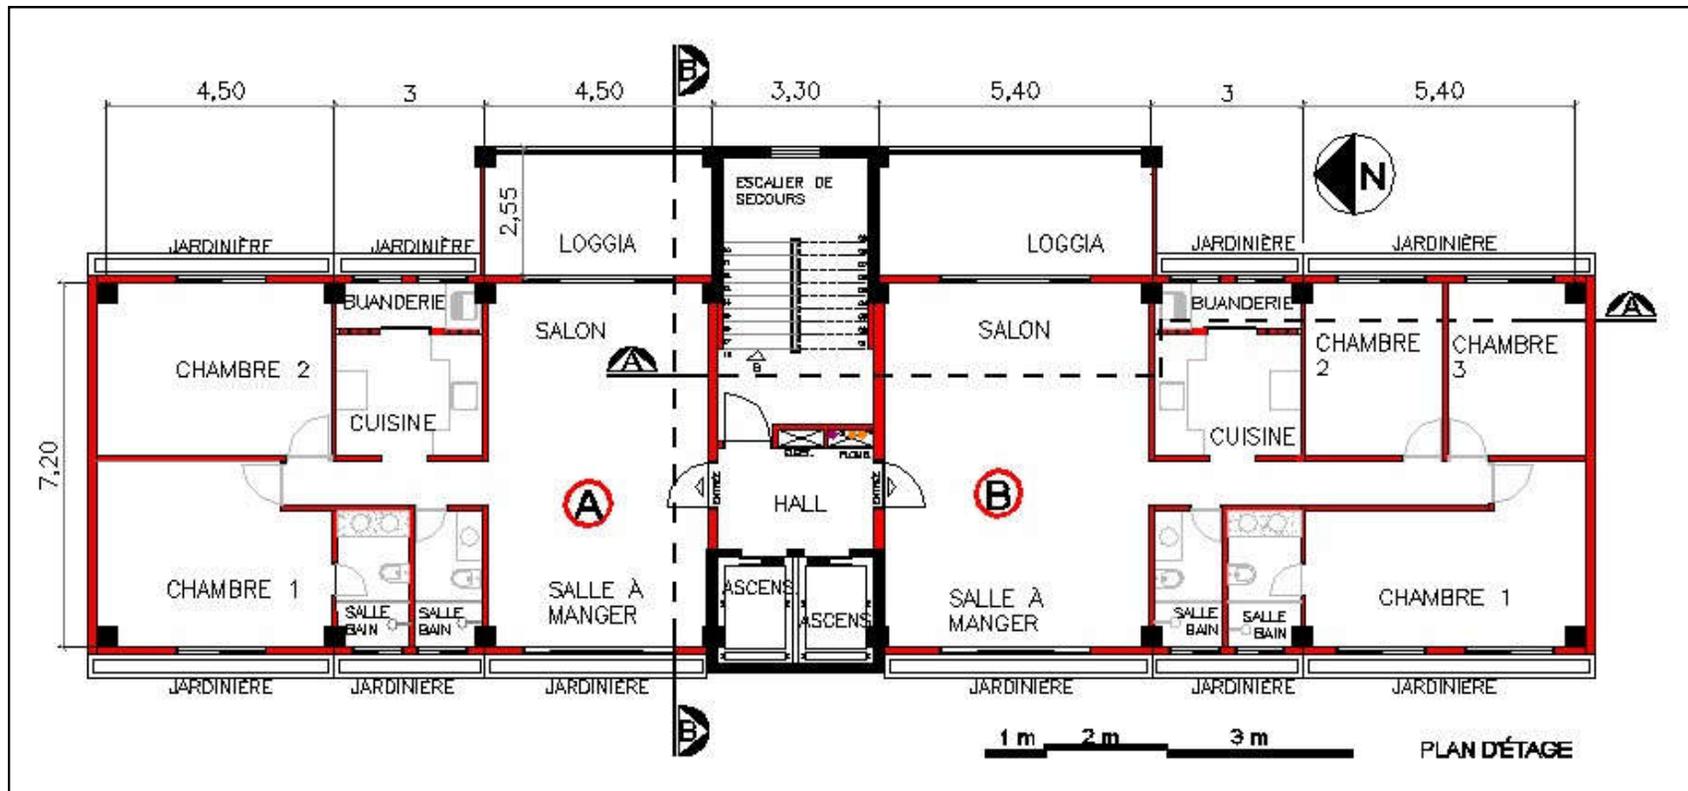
Plan d'étage appliqué au système de poutres et colonnes.
